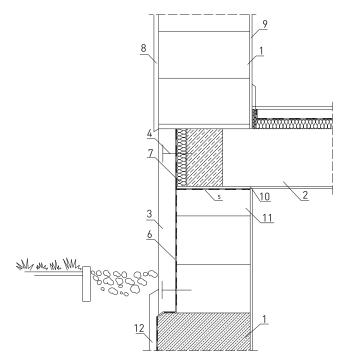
Внутренняя фундаментная стена вентилируемого неиспользуемого пространства
